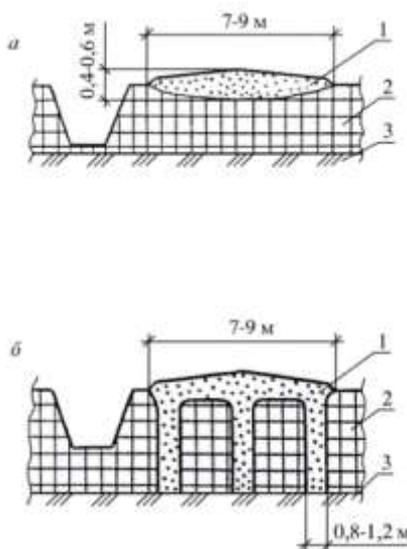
Грунтовые дороги на болотах[5]:
